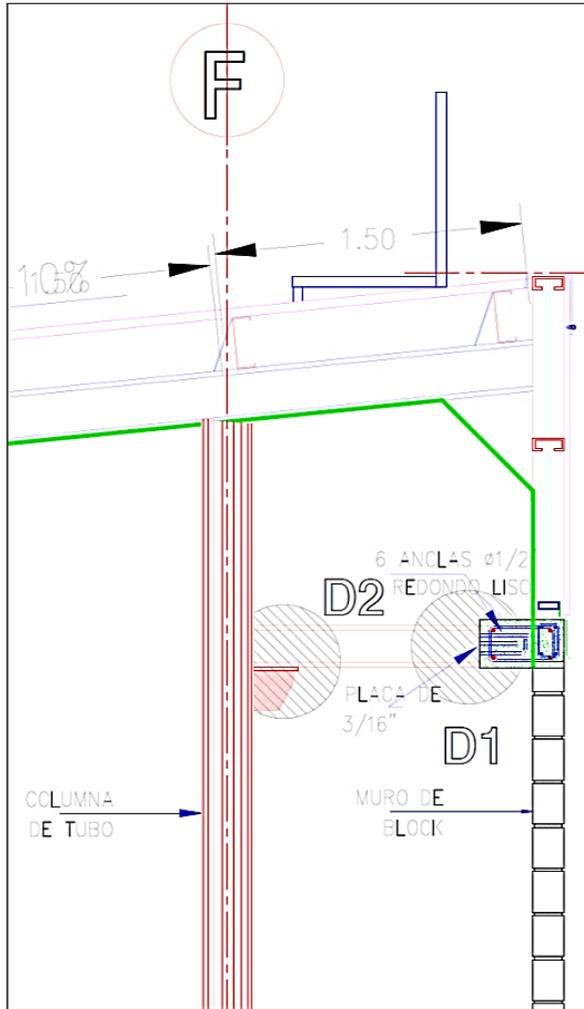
Detalle de dala de remate para cornisa en fachada principal.
